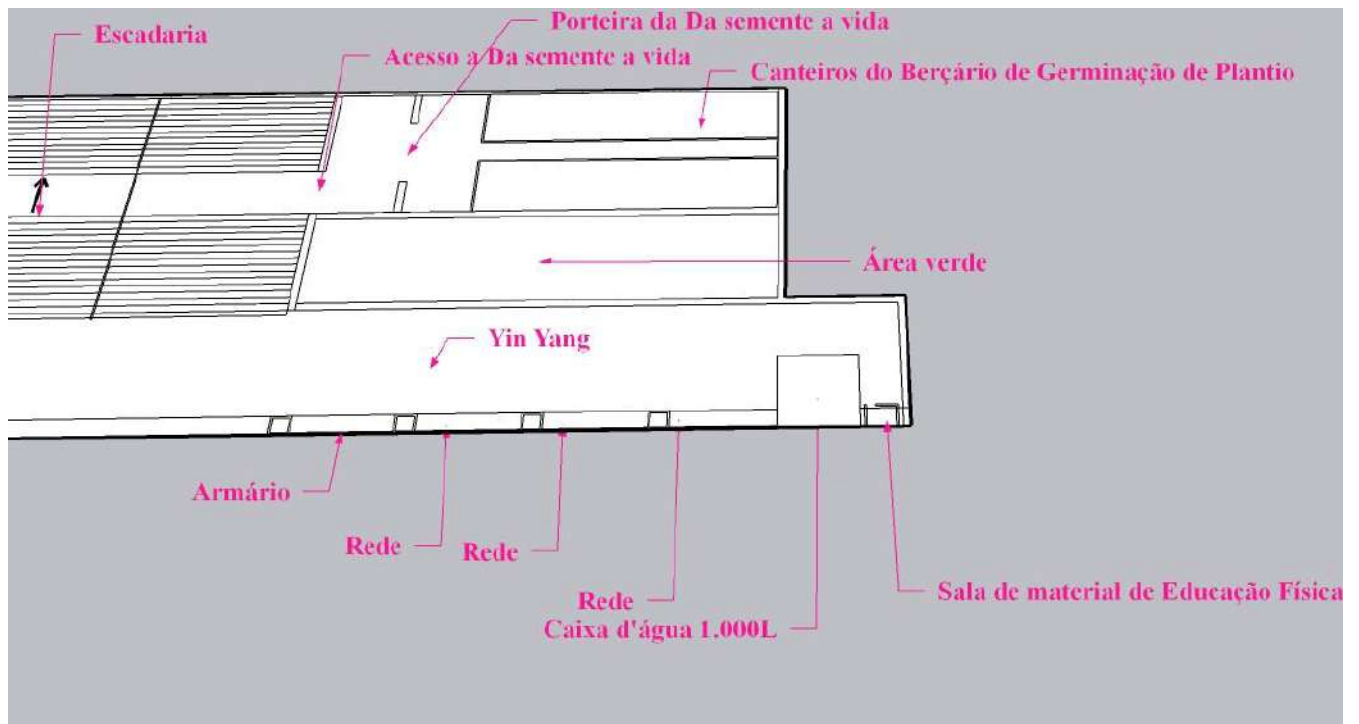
Planta baixa dos espaços Yin Yang e Da semente a Vida.
